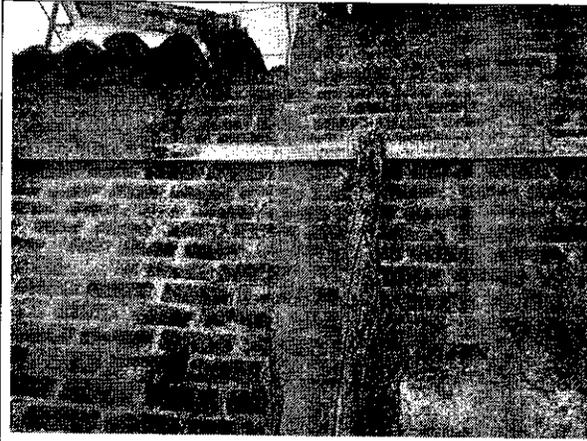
Grieta siguiendo la línea de pega entre ladrillos.
